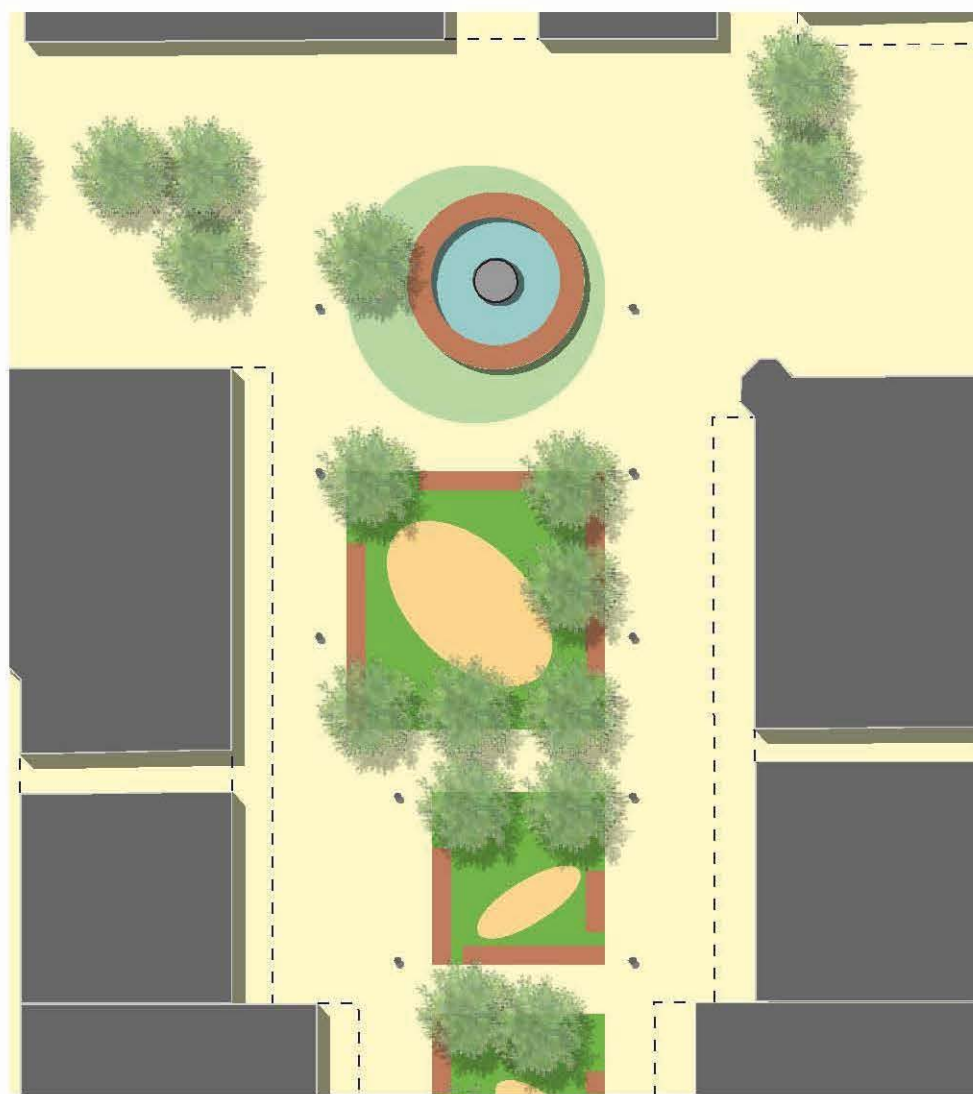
Lageplan Passage am Brunnen (o.M.)
